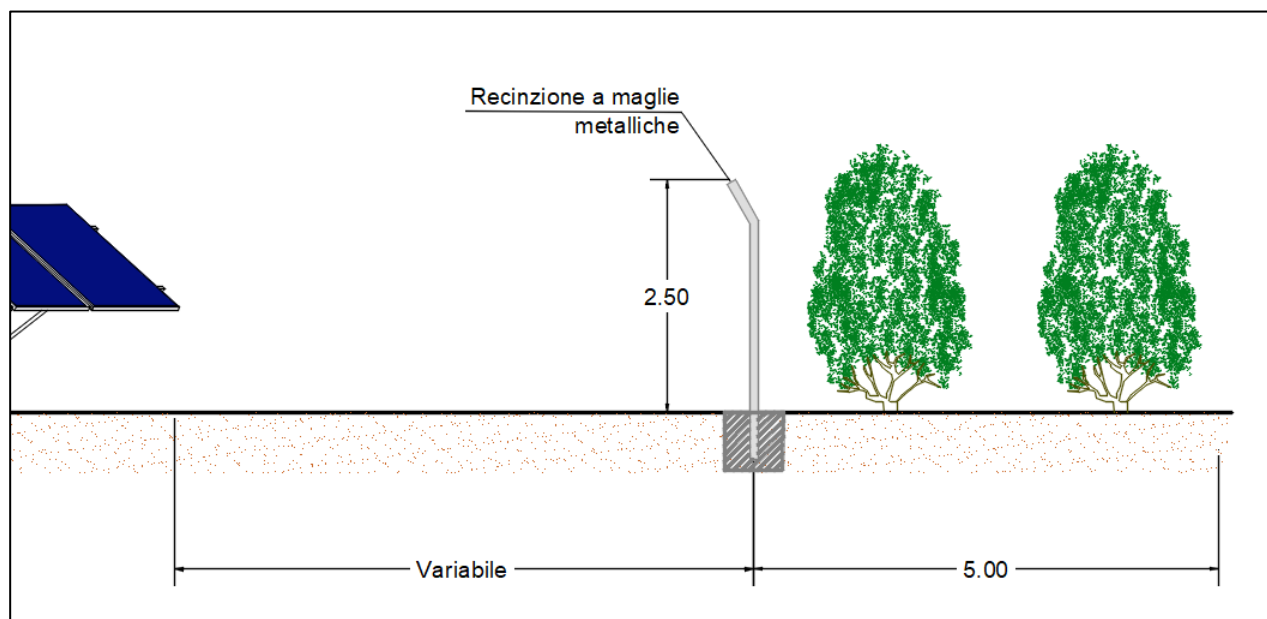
Schematizzazione delle opere di mitigazione a verde
